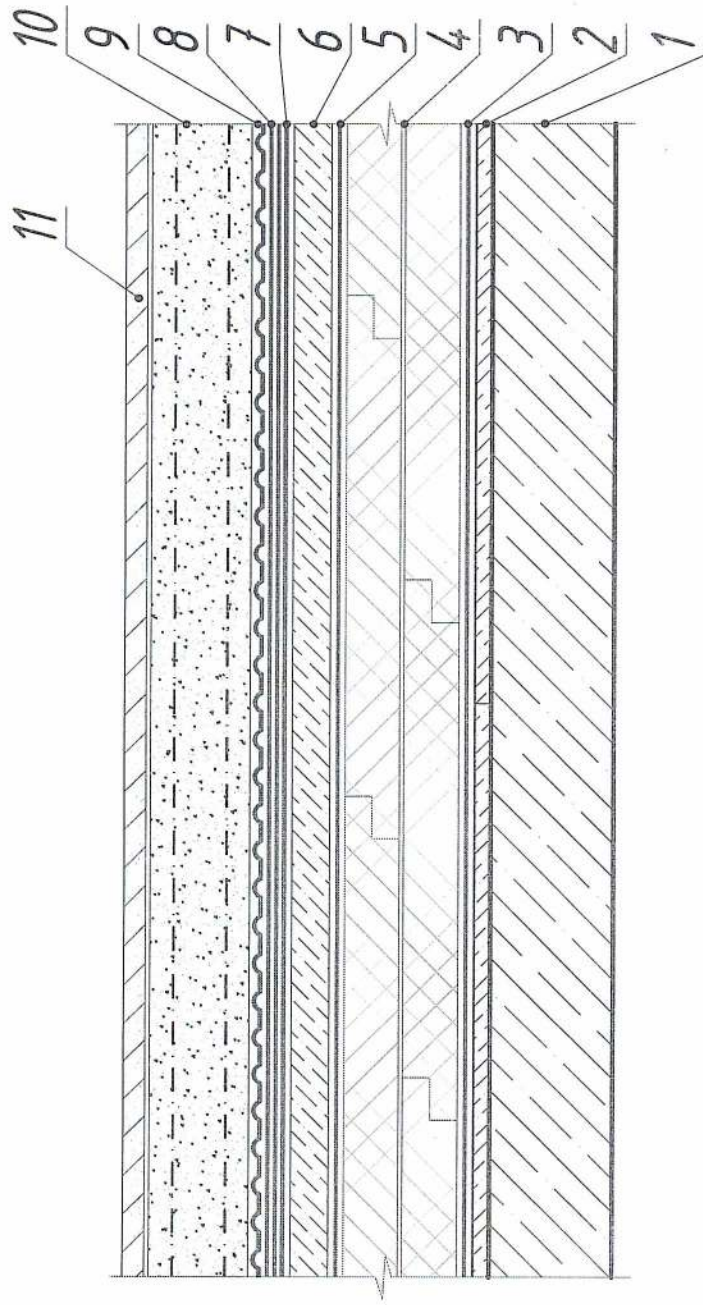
Принципиальная схема конструктивного исполнения бесчердачного покрытия выполняемого по железобетонному основанию (эксплуатируемая кровля под автомобильную нагрузку)
